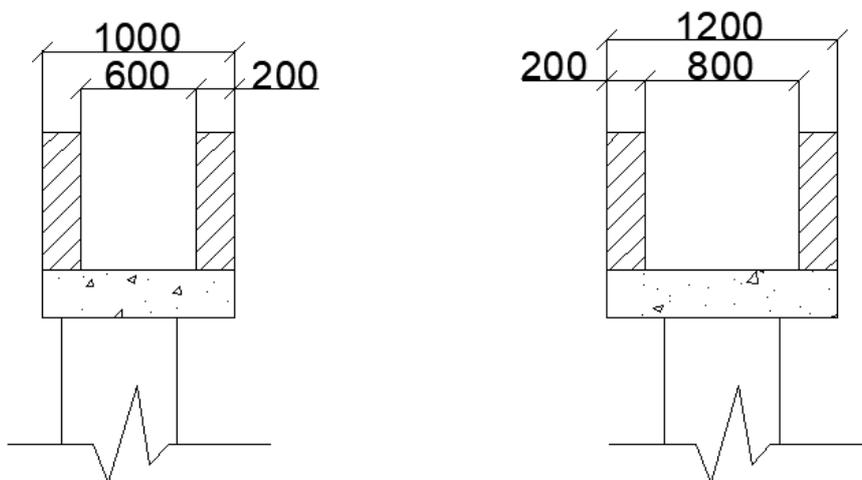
Betonagem da segunda fase (Viga-caleira)
